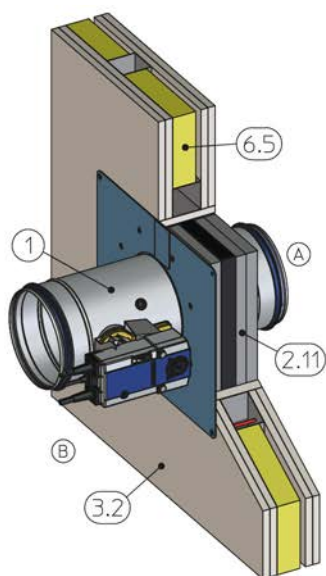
Монтаж без строительного раствора в легких перегородках без монтажного комплекта
